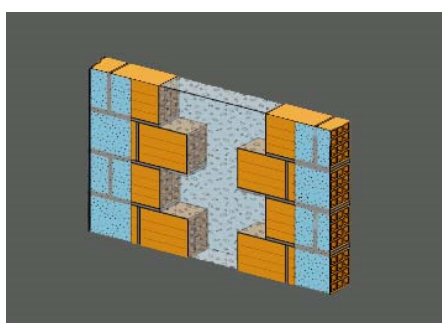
Ligação pilar/parede de tijolo (Bhatt, 2007).
